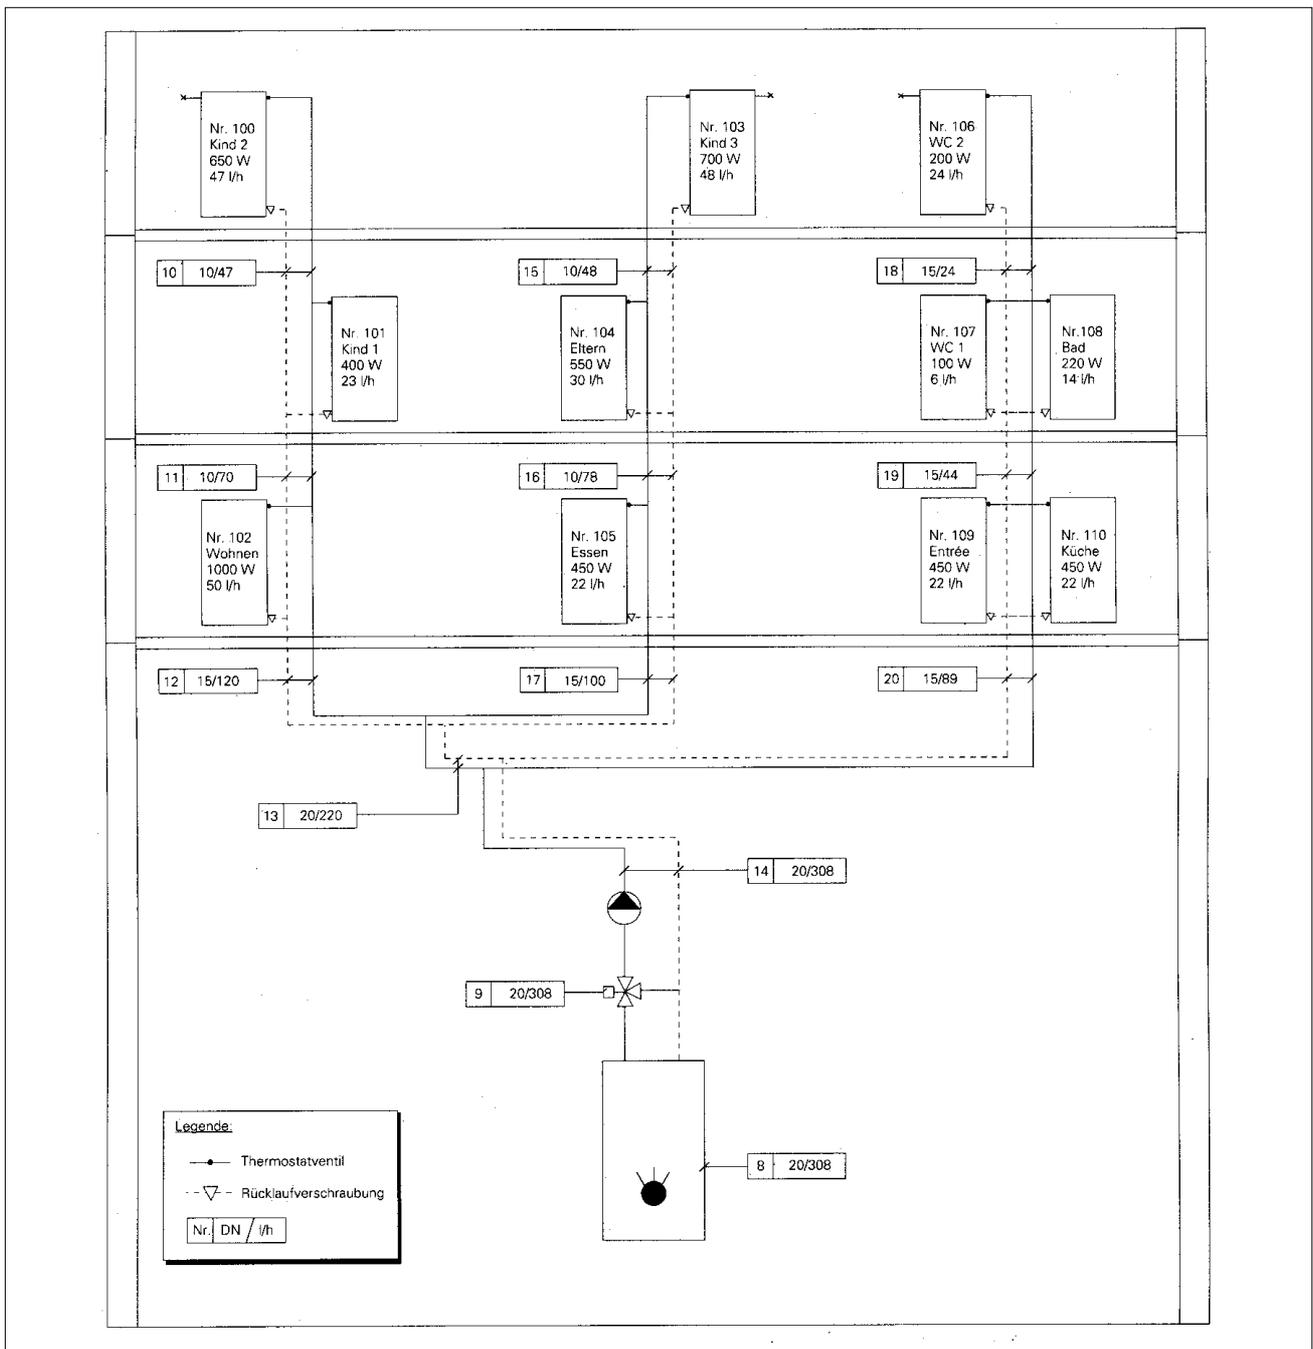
Heizungsanlage eines Einfamilienhauses (Strangschema)
